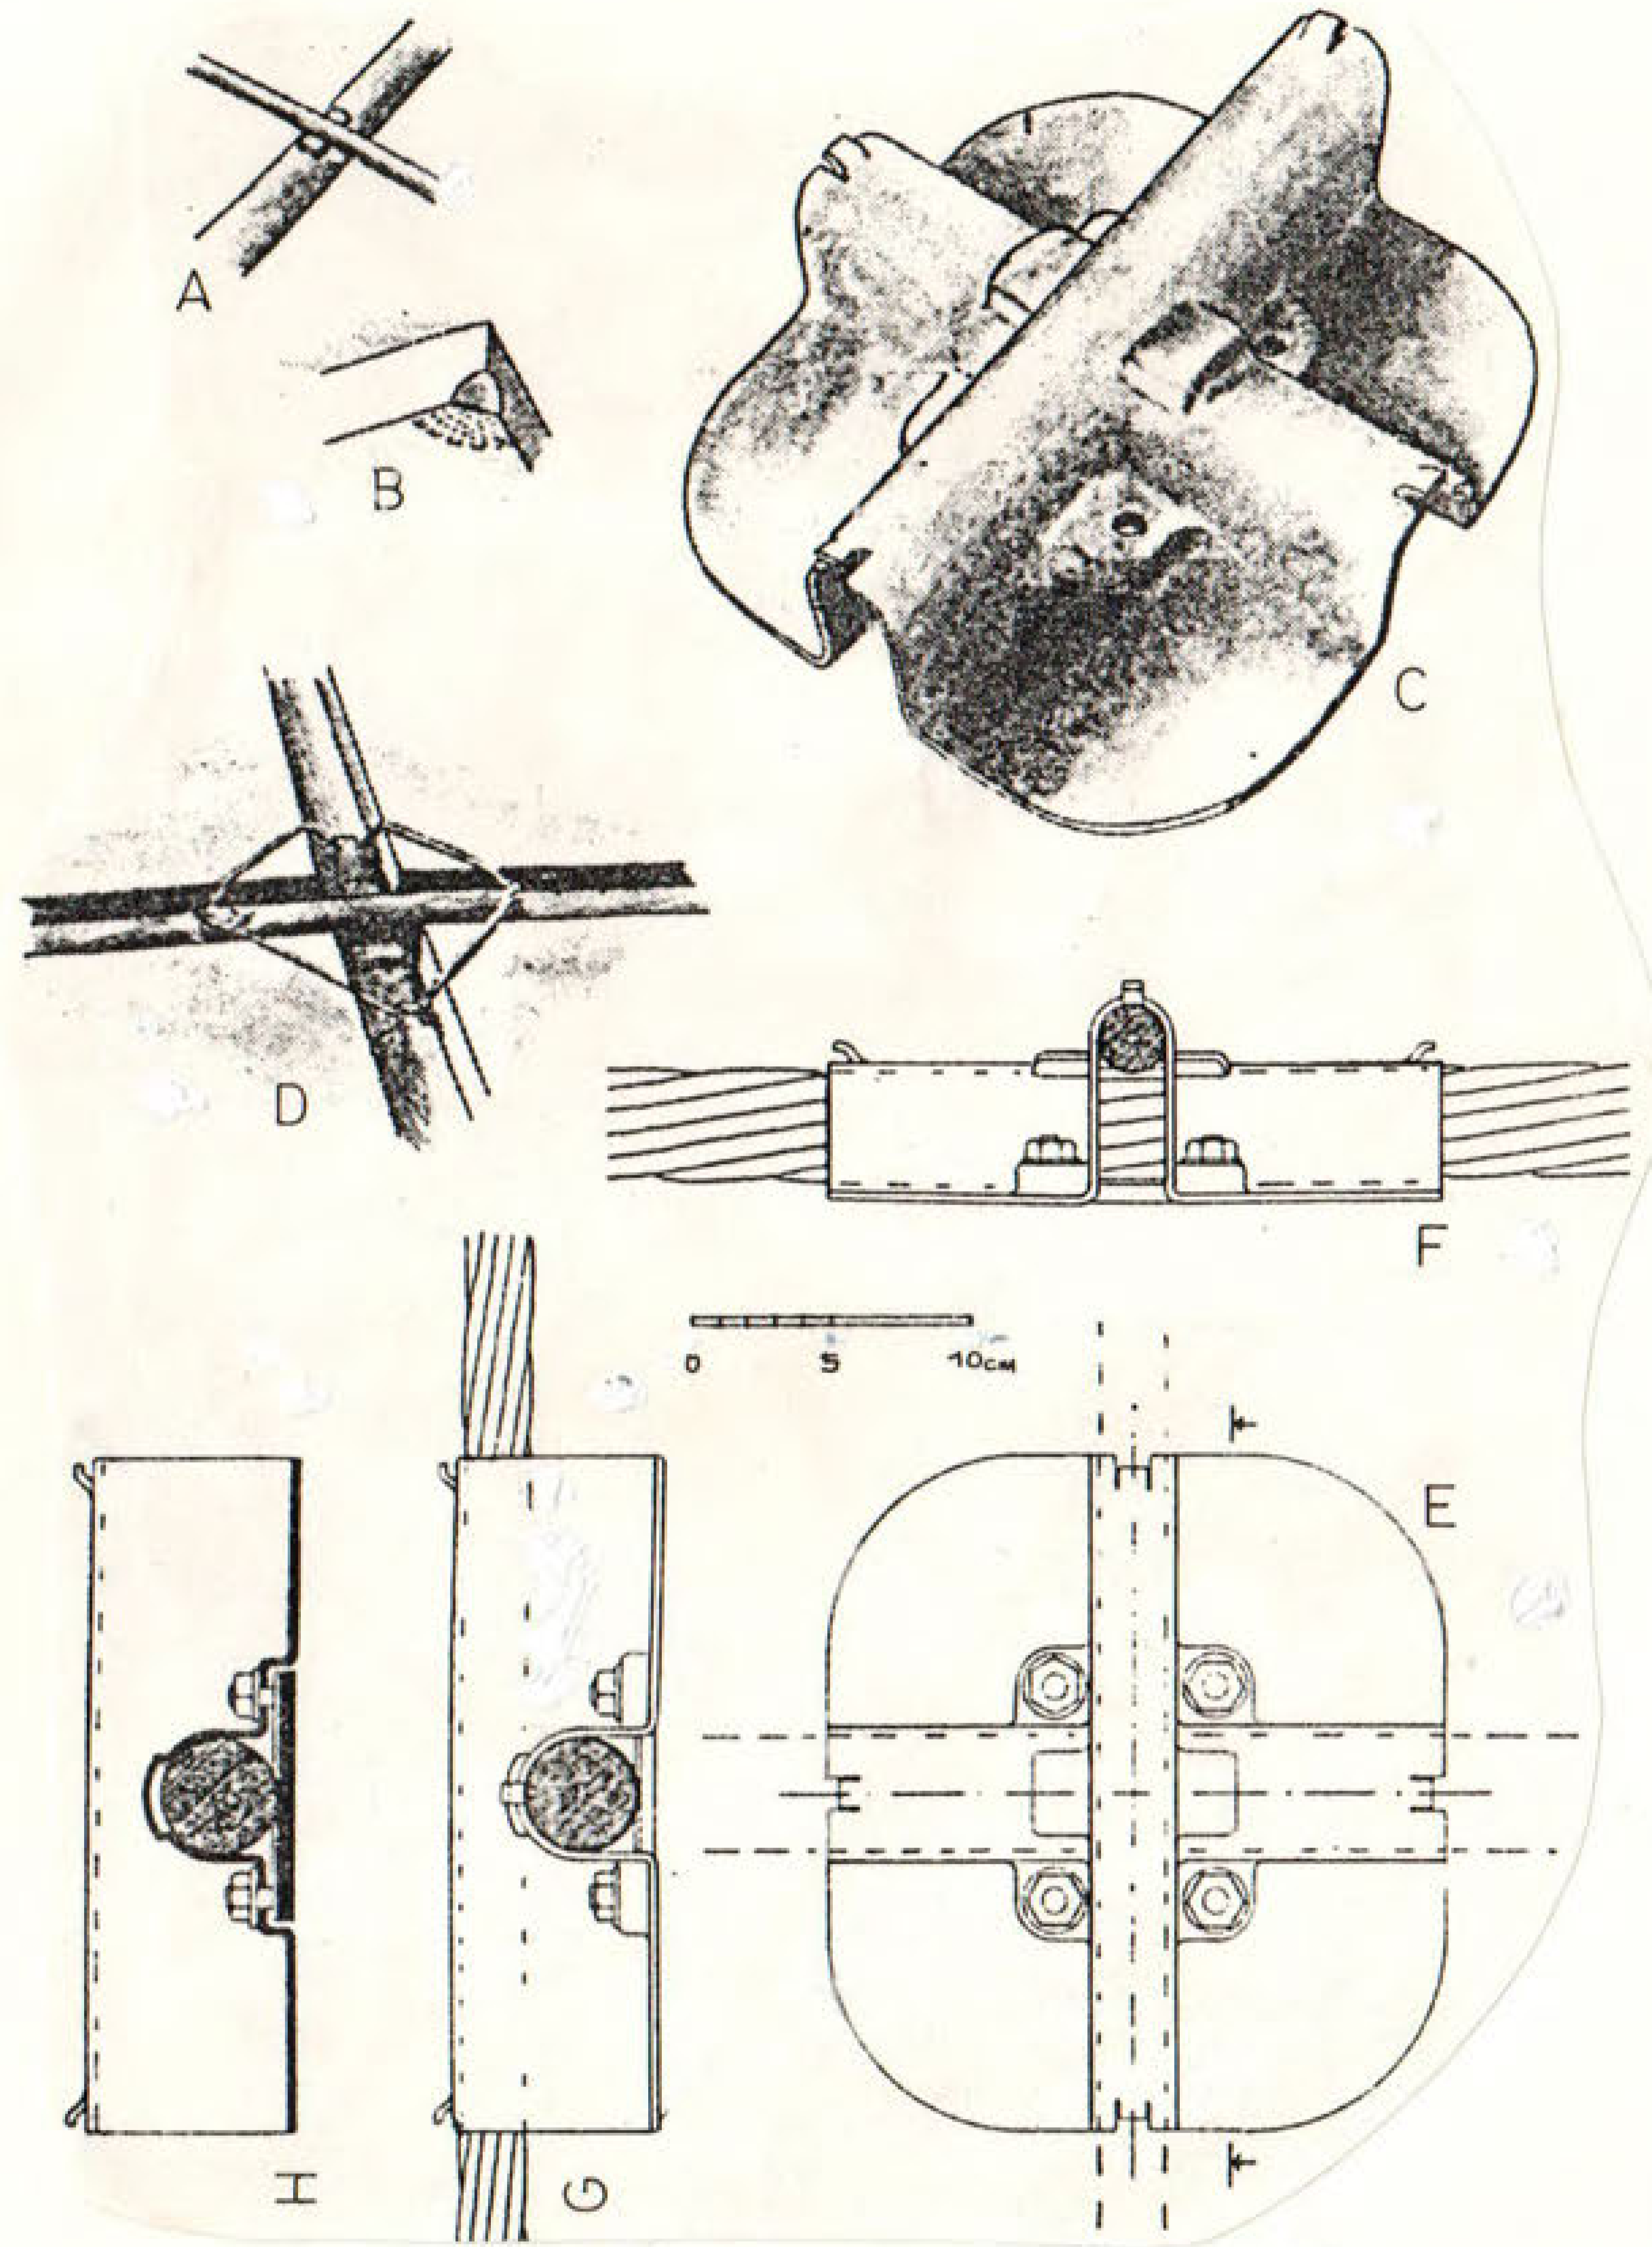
Kenetlerle asılan boşluklu beton plak örtü kaplaması detayları.
